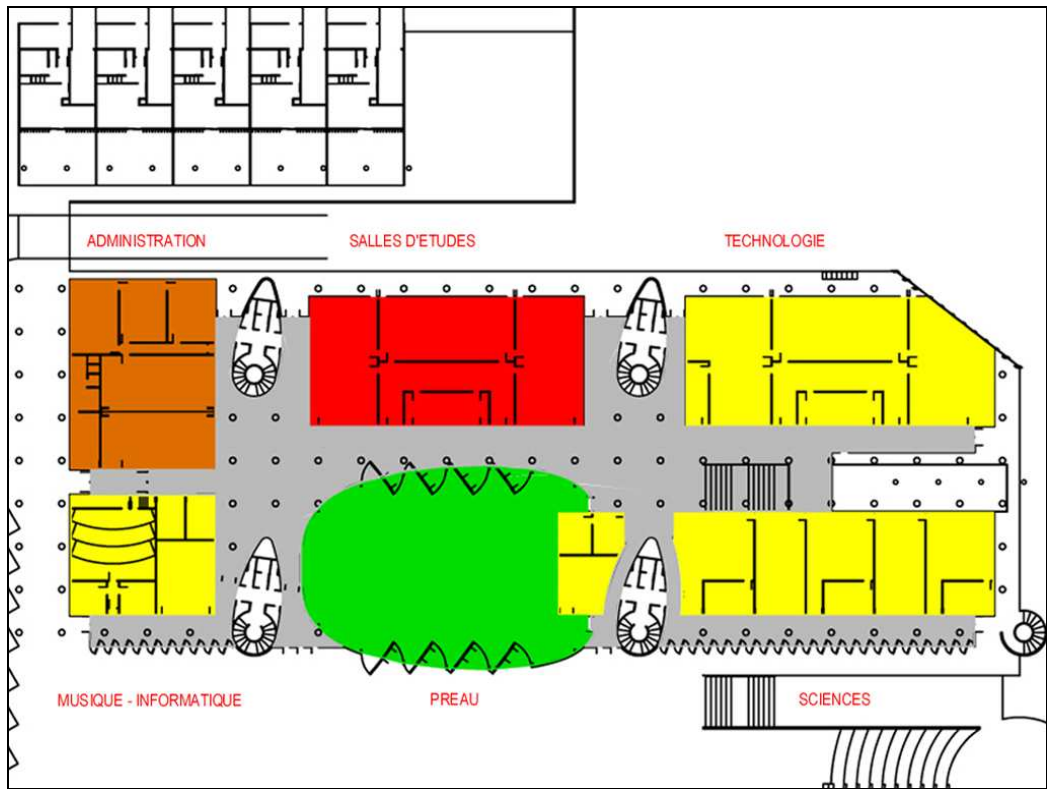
Collège Guy Dolmaire, plan rez-de-chaussée.
